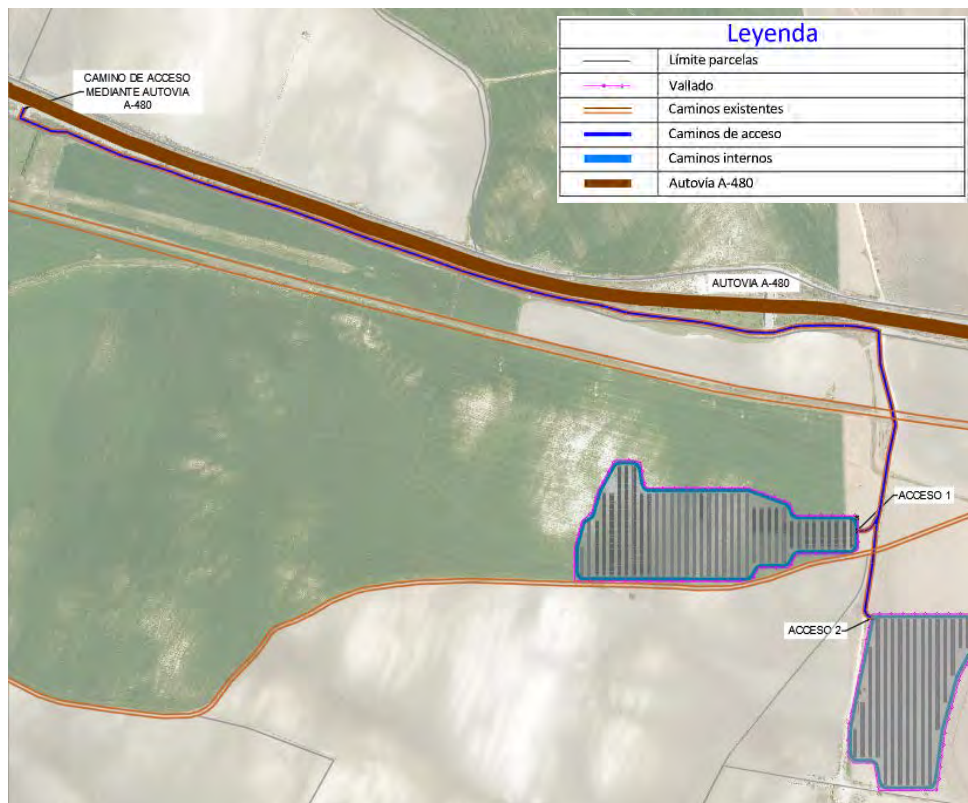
Vista de accesos planta y entronque existente con la carretera A-480
